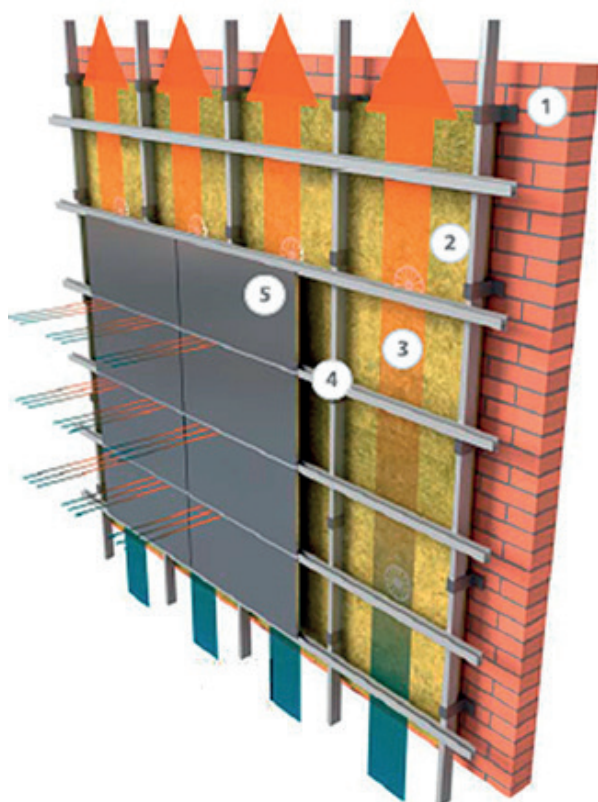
Imagen modificada para fines pertinentes de la guía. En ella se ilustra: Fachada ventilada: La imagen muestra como circularía el aire entre el muro y el material de acabado. 1. Pared o soporte. 2. Panel aislante. 3. Cámara de ventilación. 4. Subestructura. 5. Placa exterior (material de acabado)
